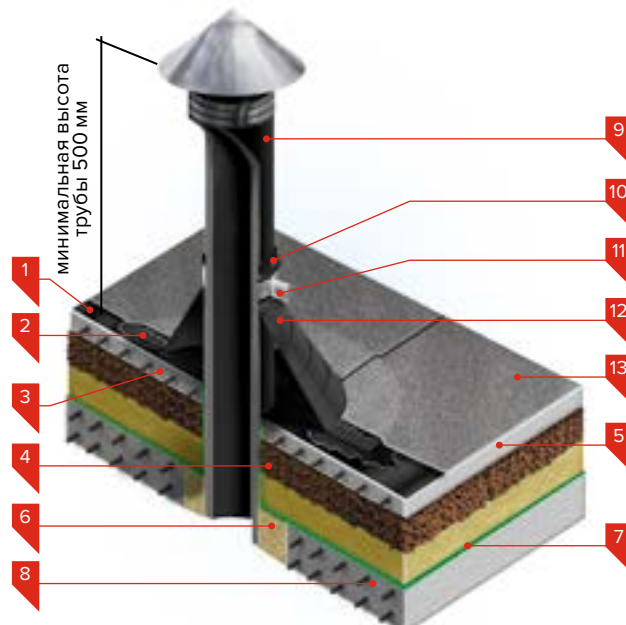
Примыкание кровли к трубе с помощью эластичного переходника
